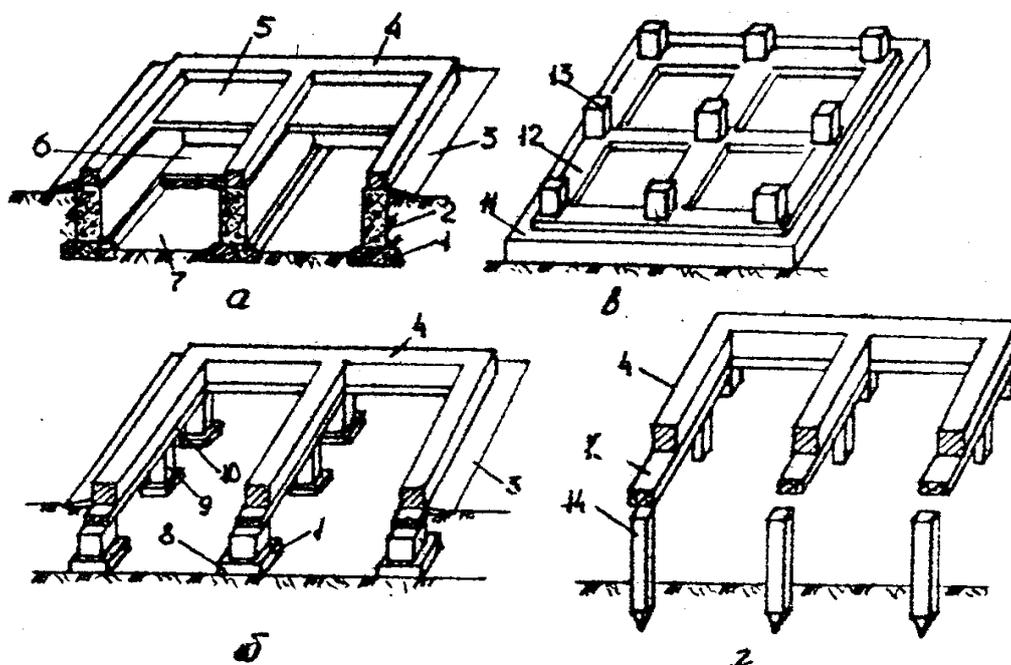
Основные типы фундаментов : а- ленточный (с подвальным помещением) ; б – столбчатый; в - сплошной ; г - свайный: 1 - подушка фундамента ; 2 - стена подвала ; 3 - то мостка ; 4 - стена здания ; 5 - перекрытие подвала ; 6 - пол подвала ; 7- основа подвала ; 8 - стакан колонны (подколонник) ; 9 - столб фундамента ; 10 - фундаментная балка (ранбалка) ; 11 - сплошной фундамент (плита) ; 12 - ребро сплошного фундамента ; 13 - колонна ; 14 - раствор (свая)
